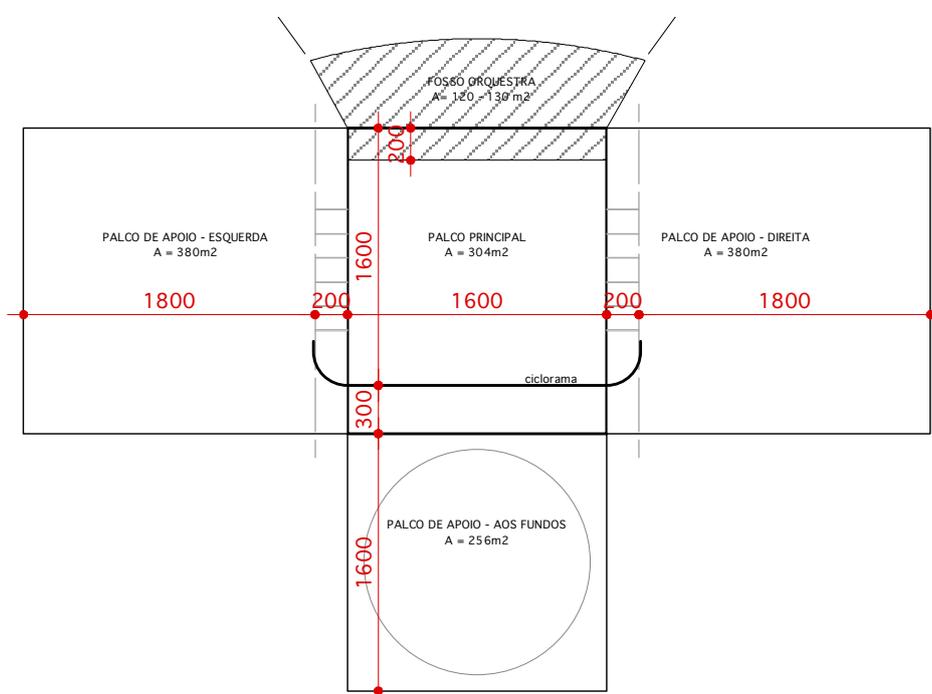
Pré-dimensionamento da caixa cênica em planta. (FONTE: a autora)
